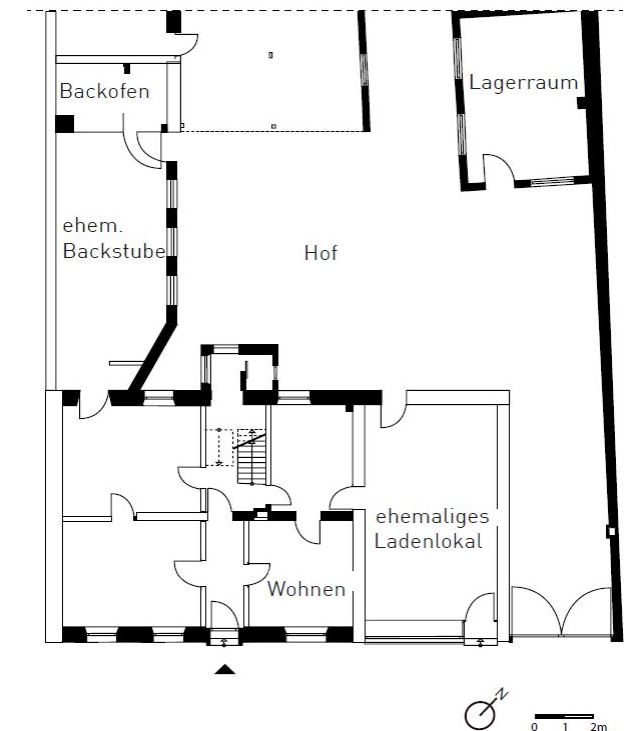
Erdgeschoss Grundriss, Oberstraße 10, 2021.
